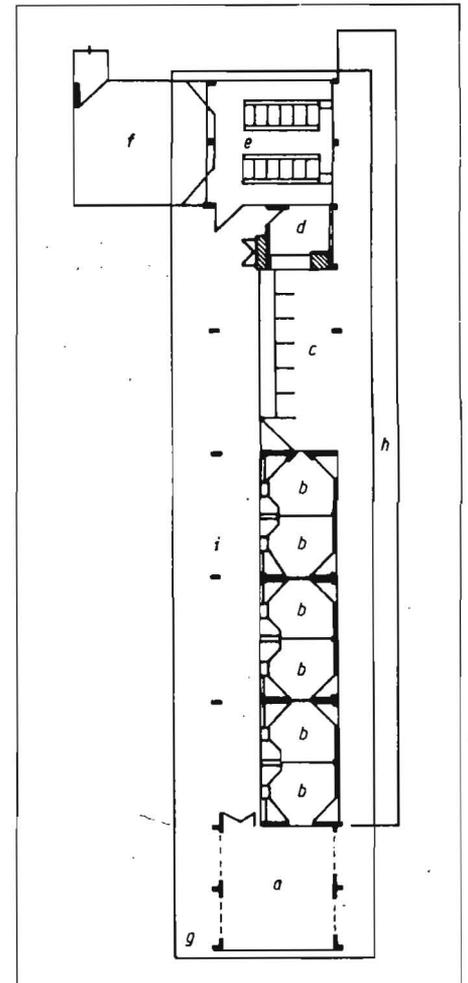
Typenprojekt einer Milchproduktionsanlage für 288 Kühe (Lageplan);
